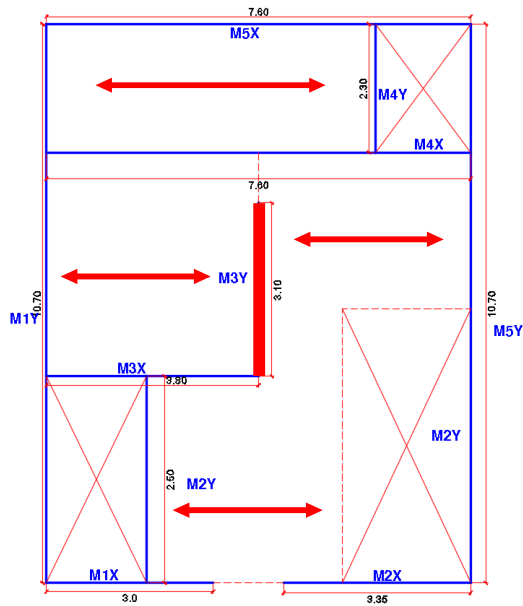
Direccionamiento de las losas aligeradas de 20 cm y muro más cargado axialmente (M3Y)
